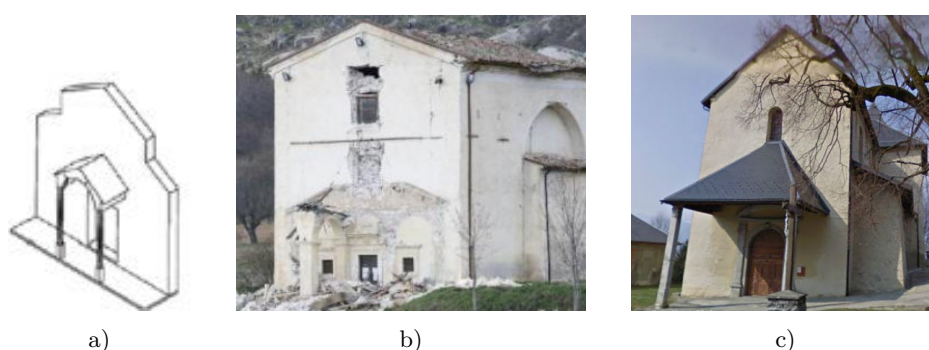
Dommages sur les portiques, auvent et narthex. a) Mécanisme, (Papa et Pasquale, 2013). b) Effondrement du portique, Madonella del Lago, Santo Stefano di Sessanio. c) Auvent encastré dans la façade, fissures aux appuis, Saint Laurent, Aiton
